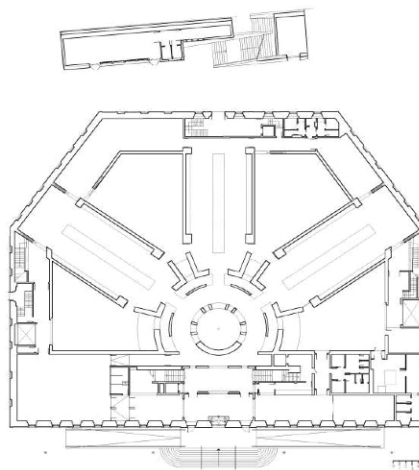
| Planta do actual Museu de Vigo _ MARCO
